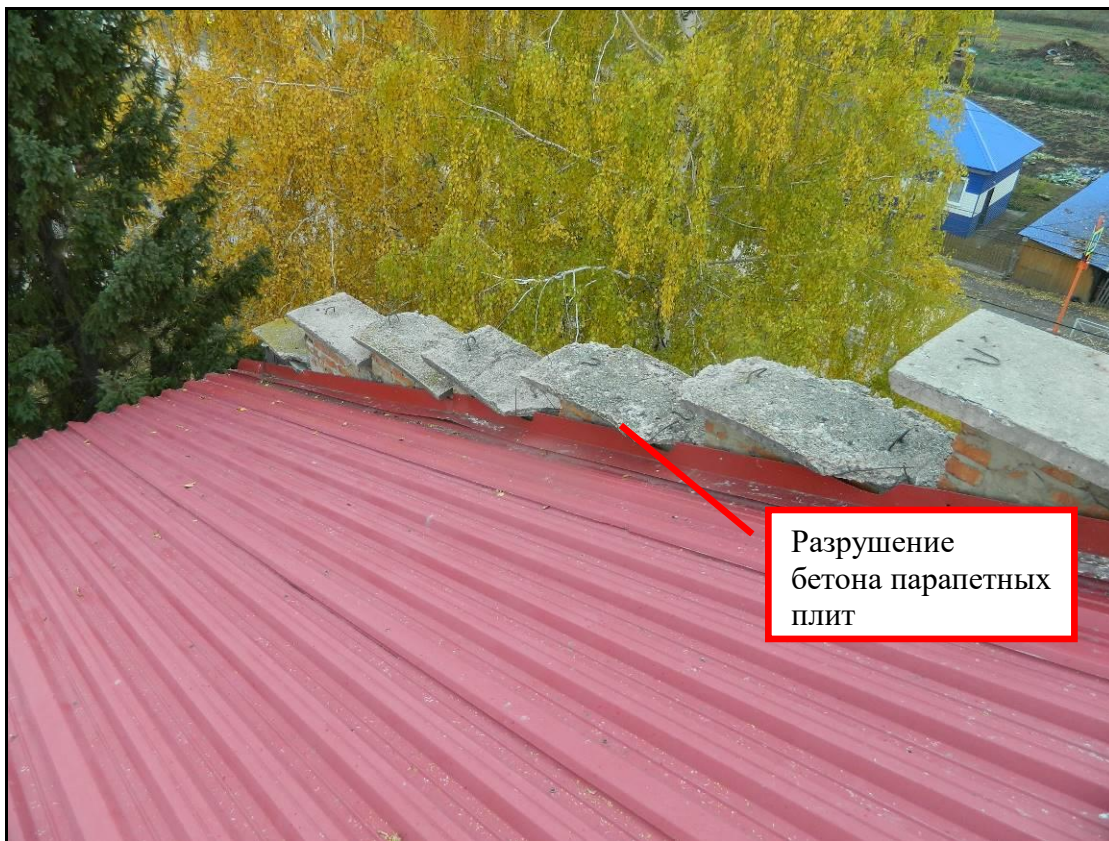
Фрагмент кровли в осях «1/А-Г»
